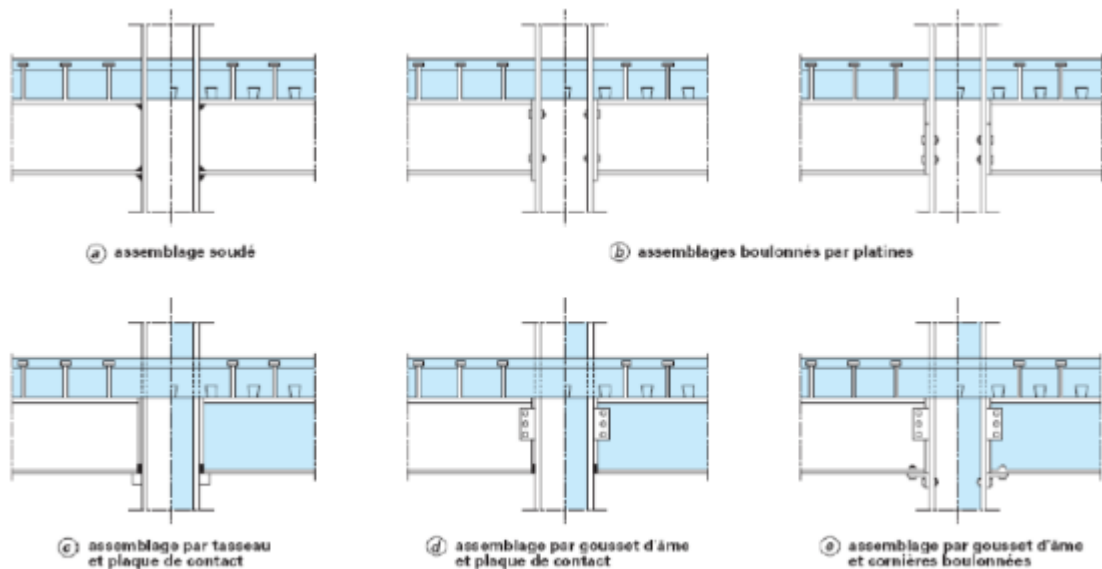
assemblage de type poutre/poteau pour des ossatures mixtes semi-continues
